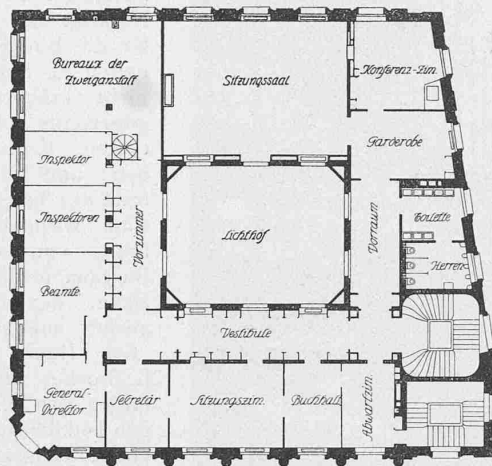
Grundriss vom zweiten Obergeschoss.
